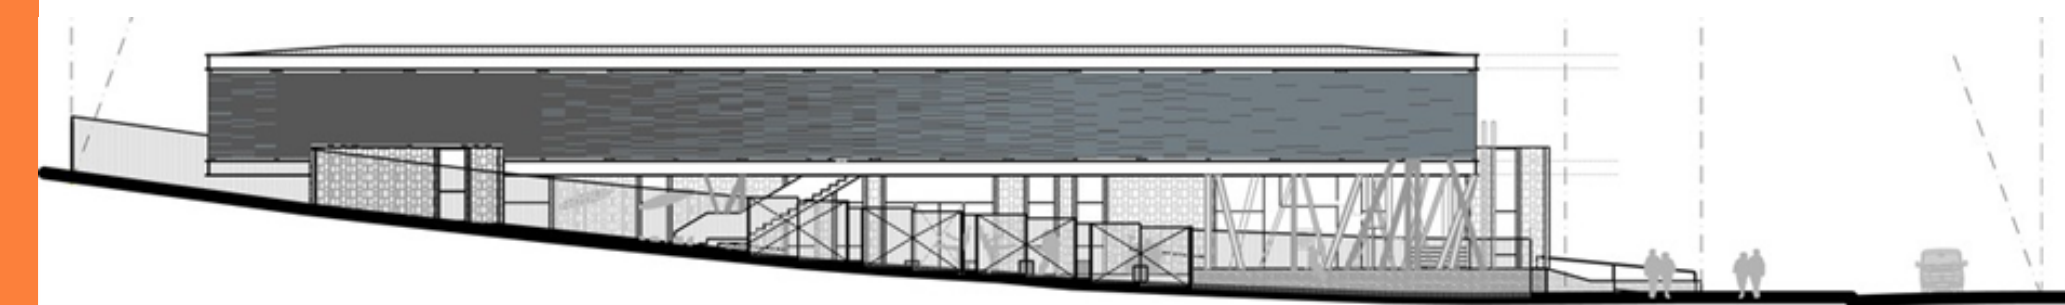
Fachada Leste do Centro Cultural El Tranque.
